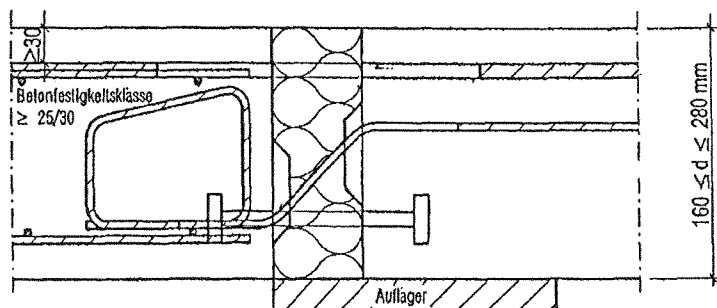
Beispiel Schöck Isokorb Typ KX mit integrierter Aufhängebewehrung
